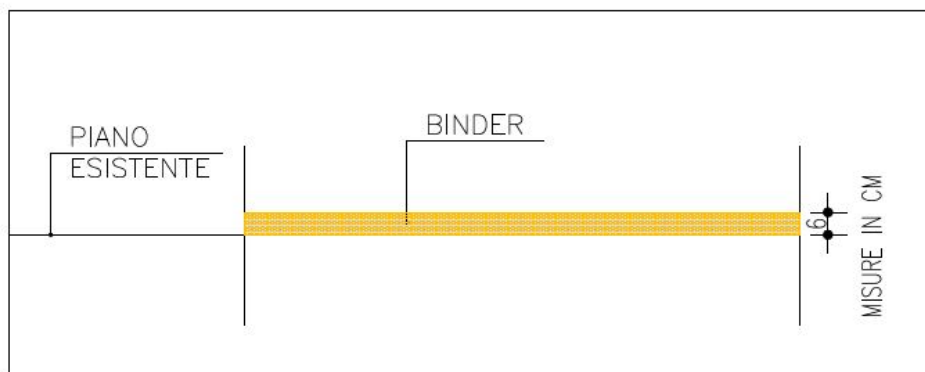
Particolare pavimentazione del cantiere CO18W da demolire
